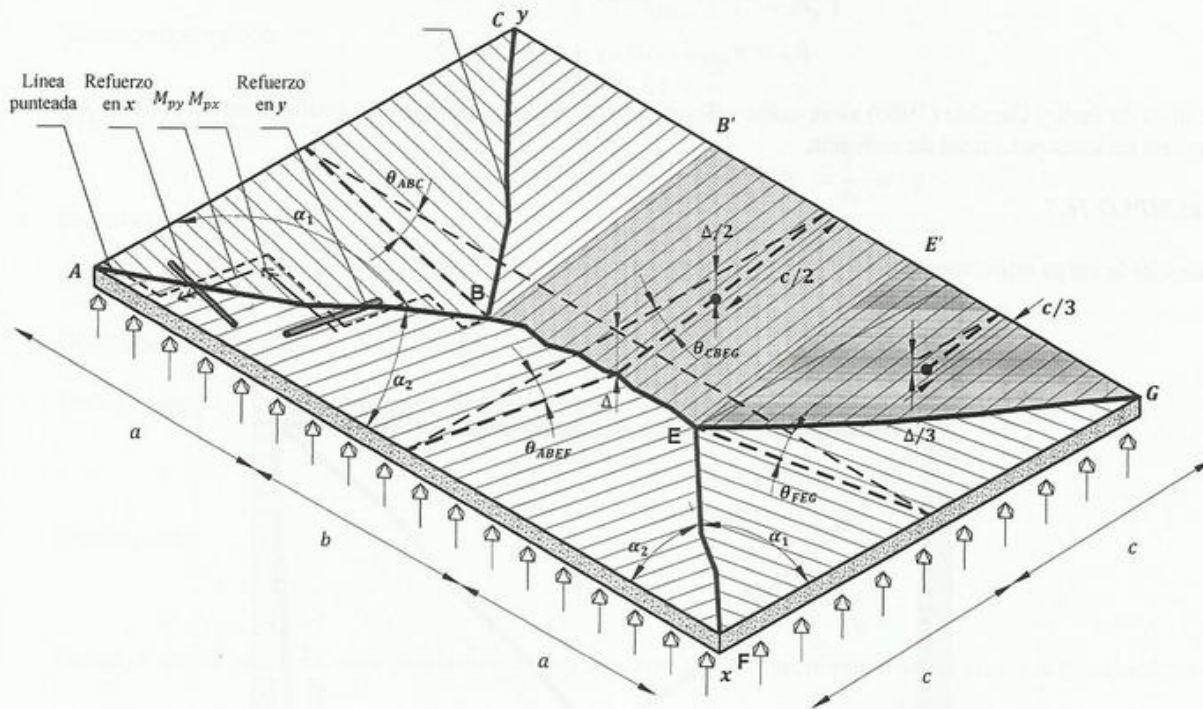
Mecanismo de colapso de una losa con refuerzo en dos direcciones
